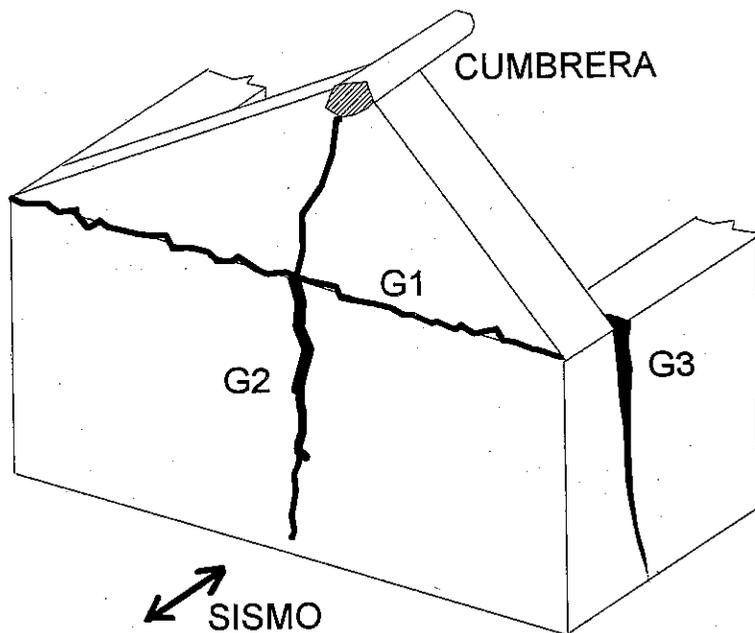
GRIETAS EN LOS MUROS POR ACCIONES SISMICAS PERPENDICULARES AL PLANO.
